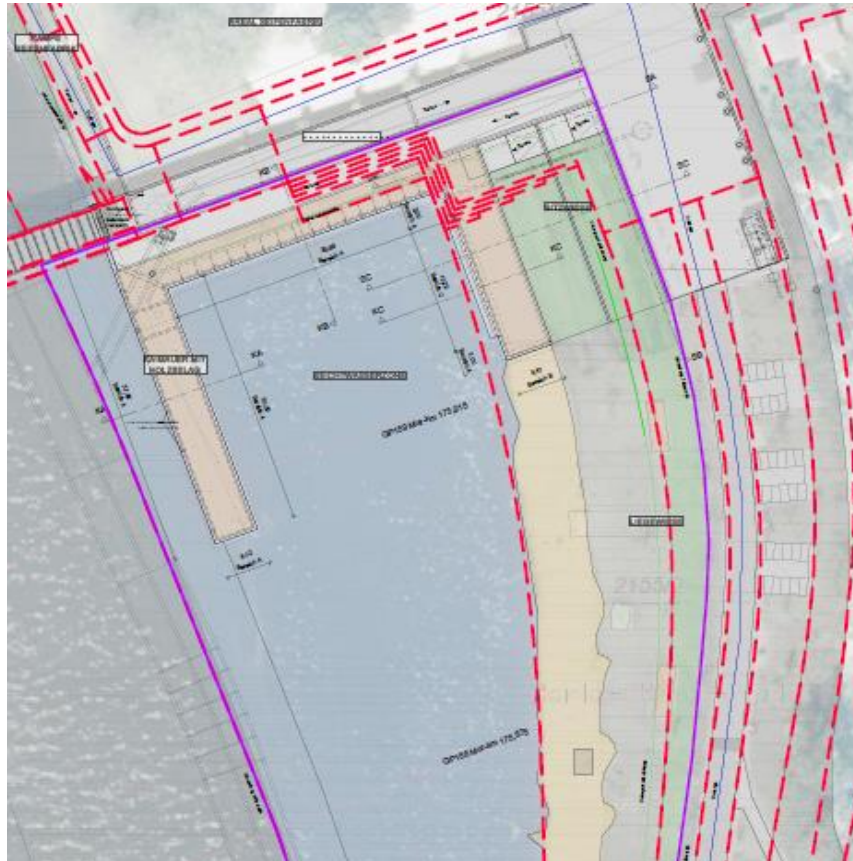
Lageplan Ausführung (MKWG\_KO\_SWZ\_Grünanger\_Teilbereich\_Vergleich\_20250110)
